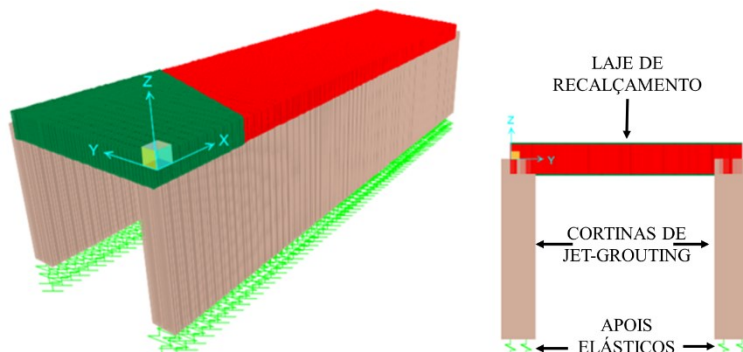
Modelo de análise SAP2000 para a laje de fundação.
